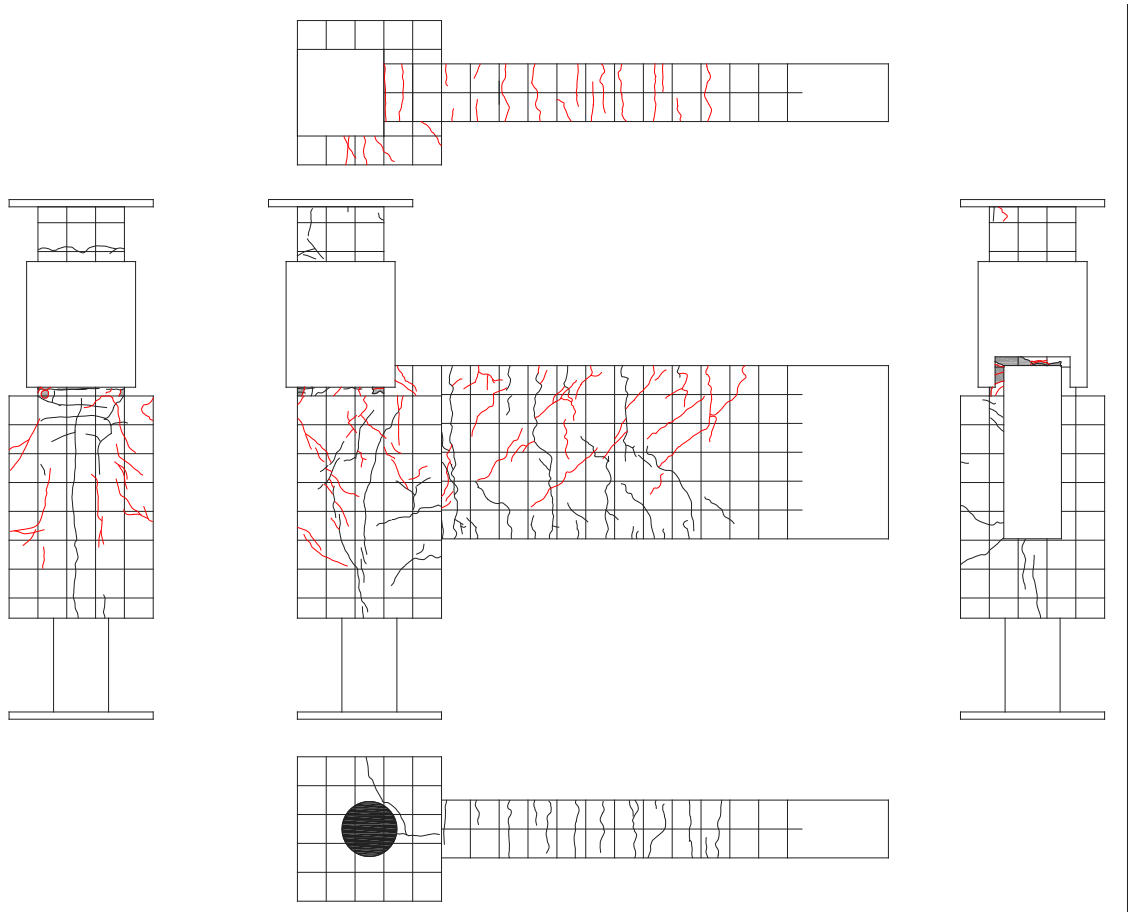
3. 96 試験体 C-2 ひび割れ状況 (5Cycle)
